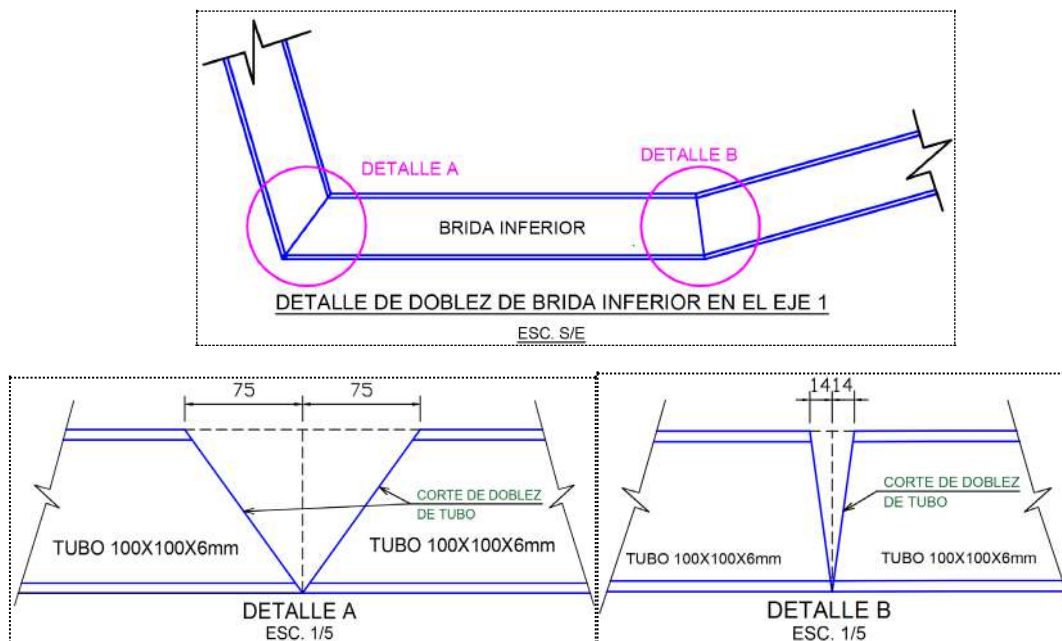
Detalle de armado y destaje de celosía del tijeral metálico
